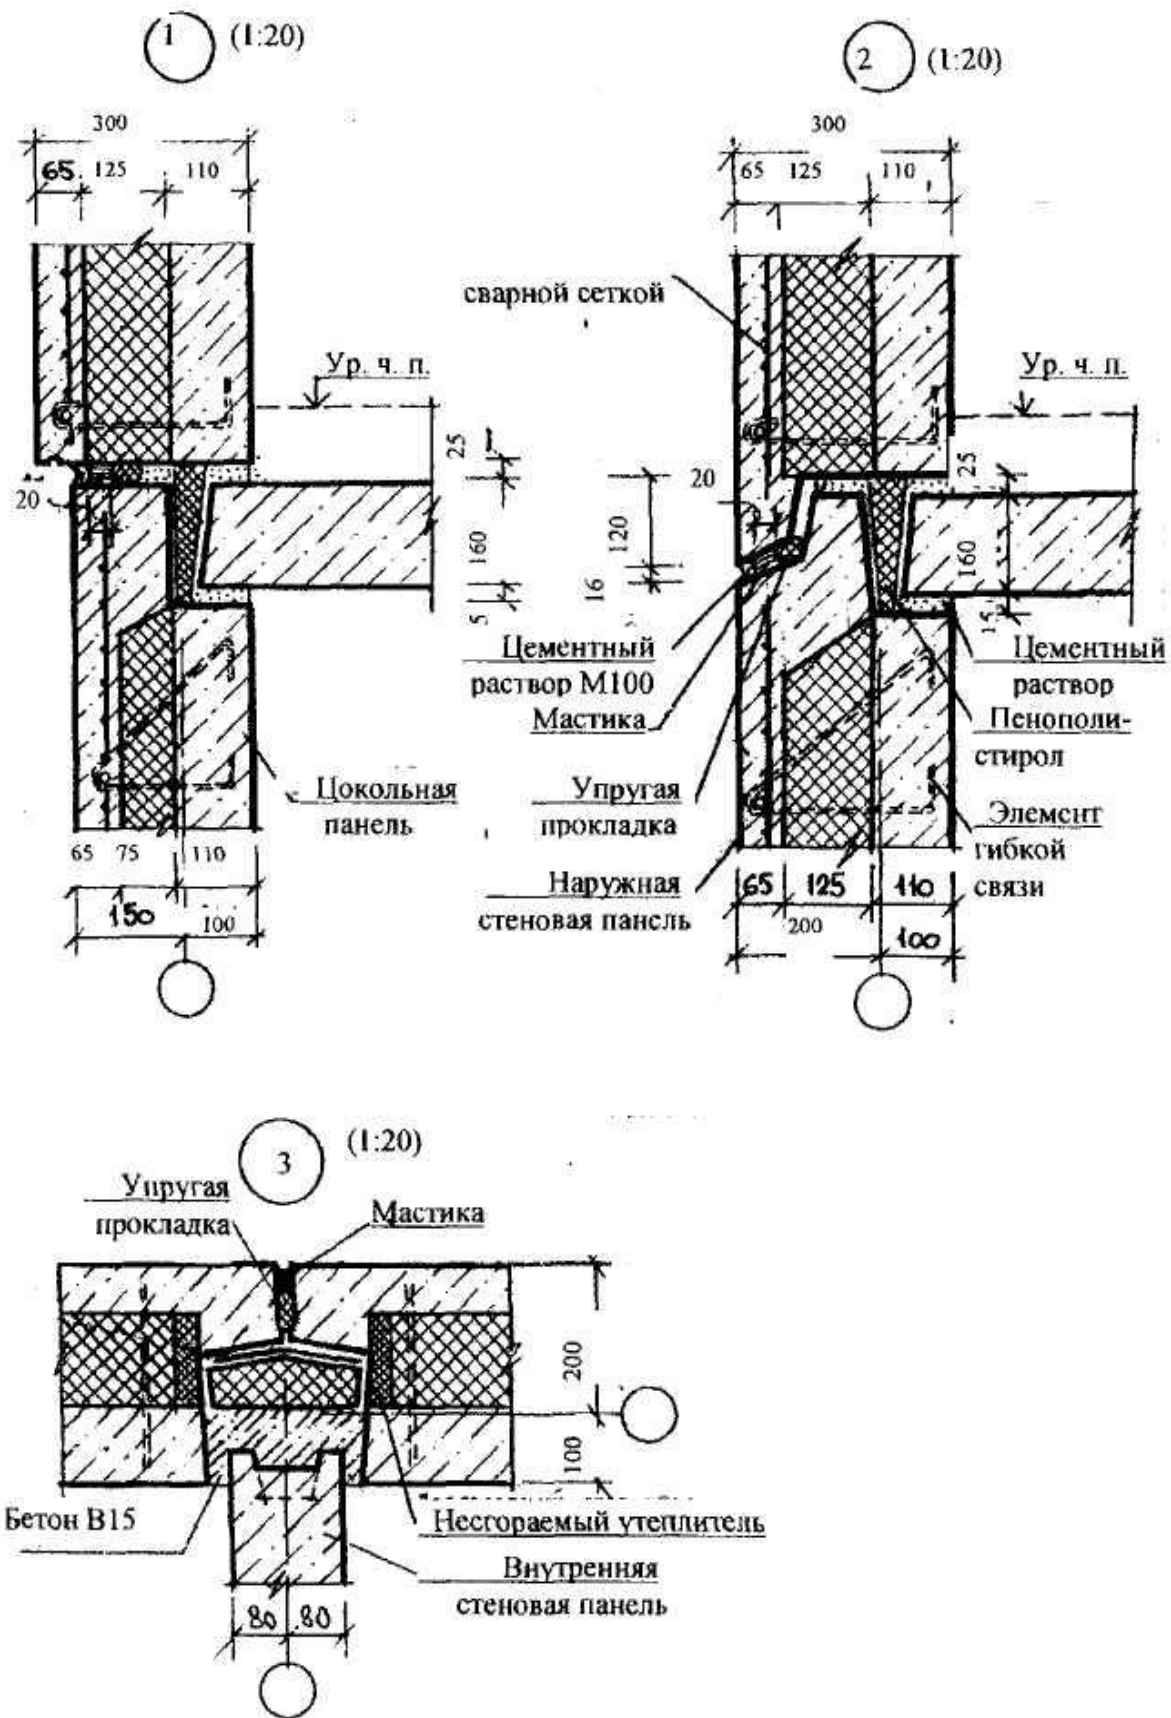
Примеры выполнения конструктивных узлов трехслойных стеновых наружных панелей с гибкими связями
